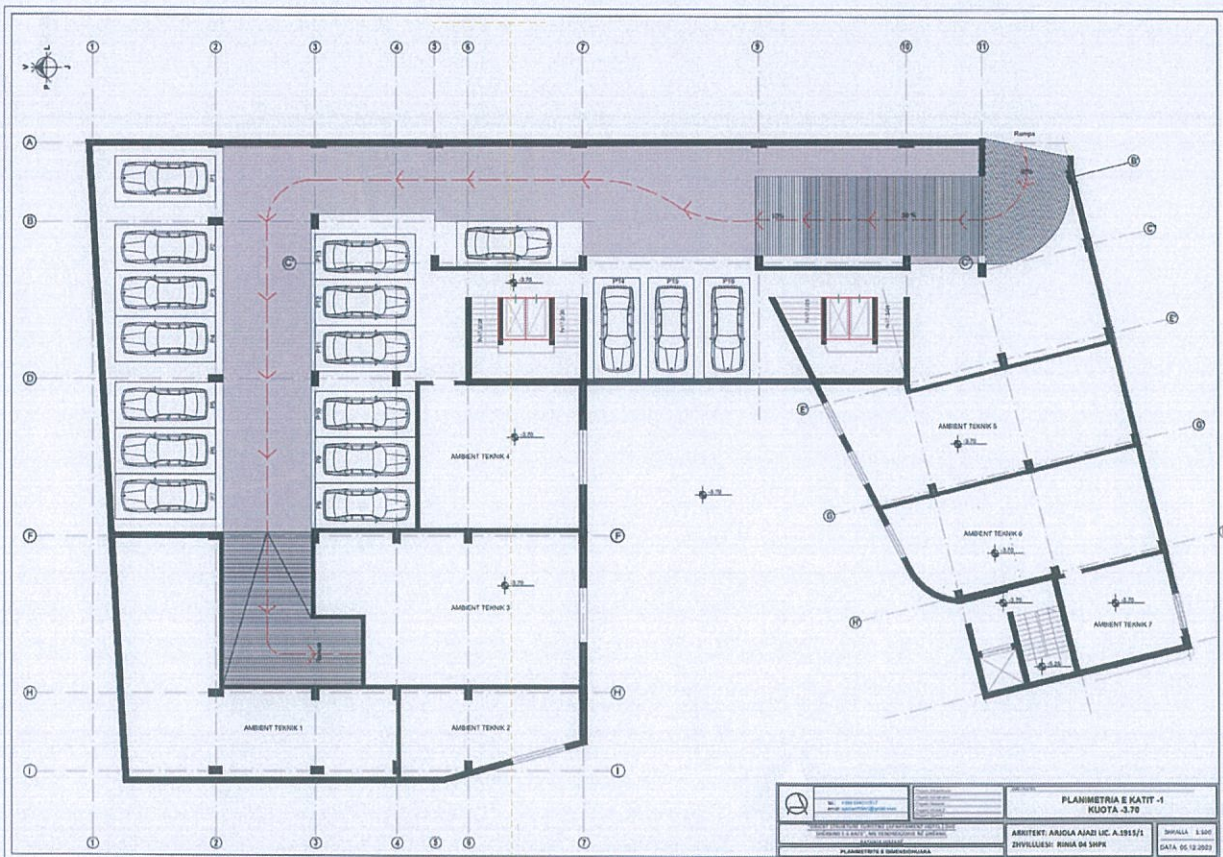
Planimetri e katit nentoke (kuota – 3.70)
